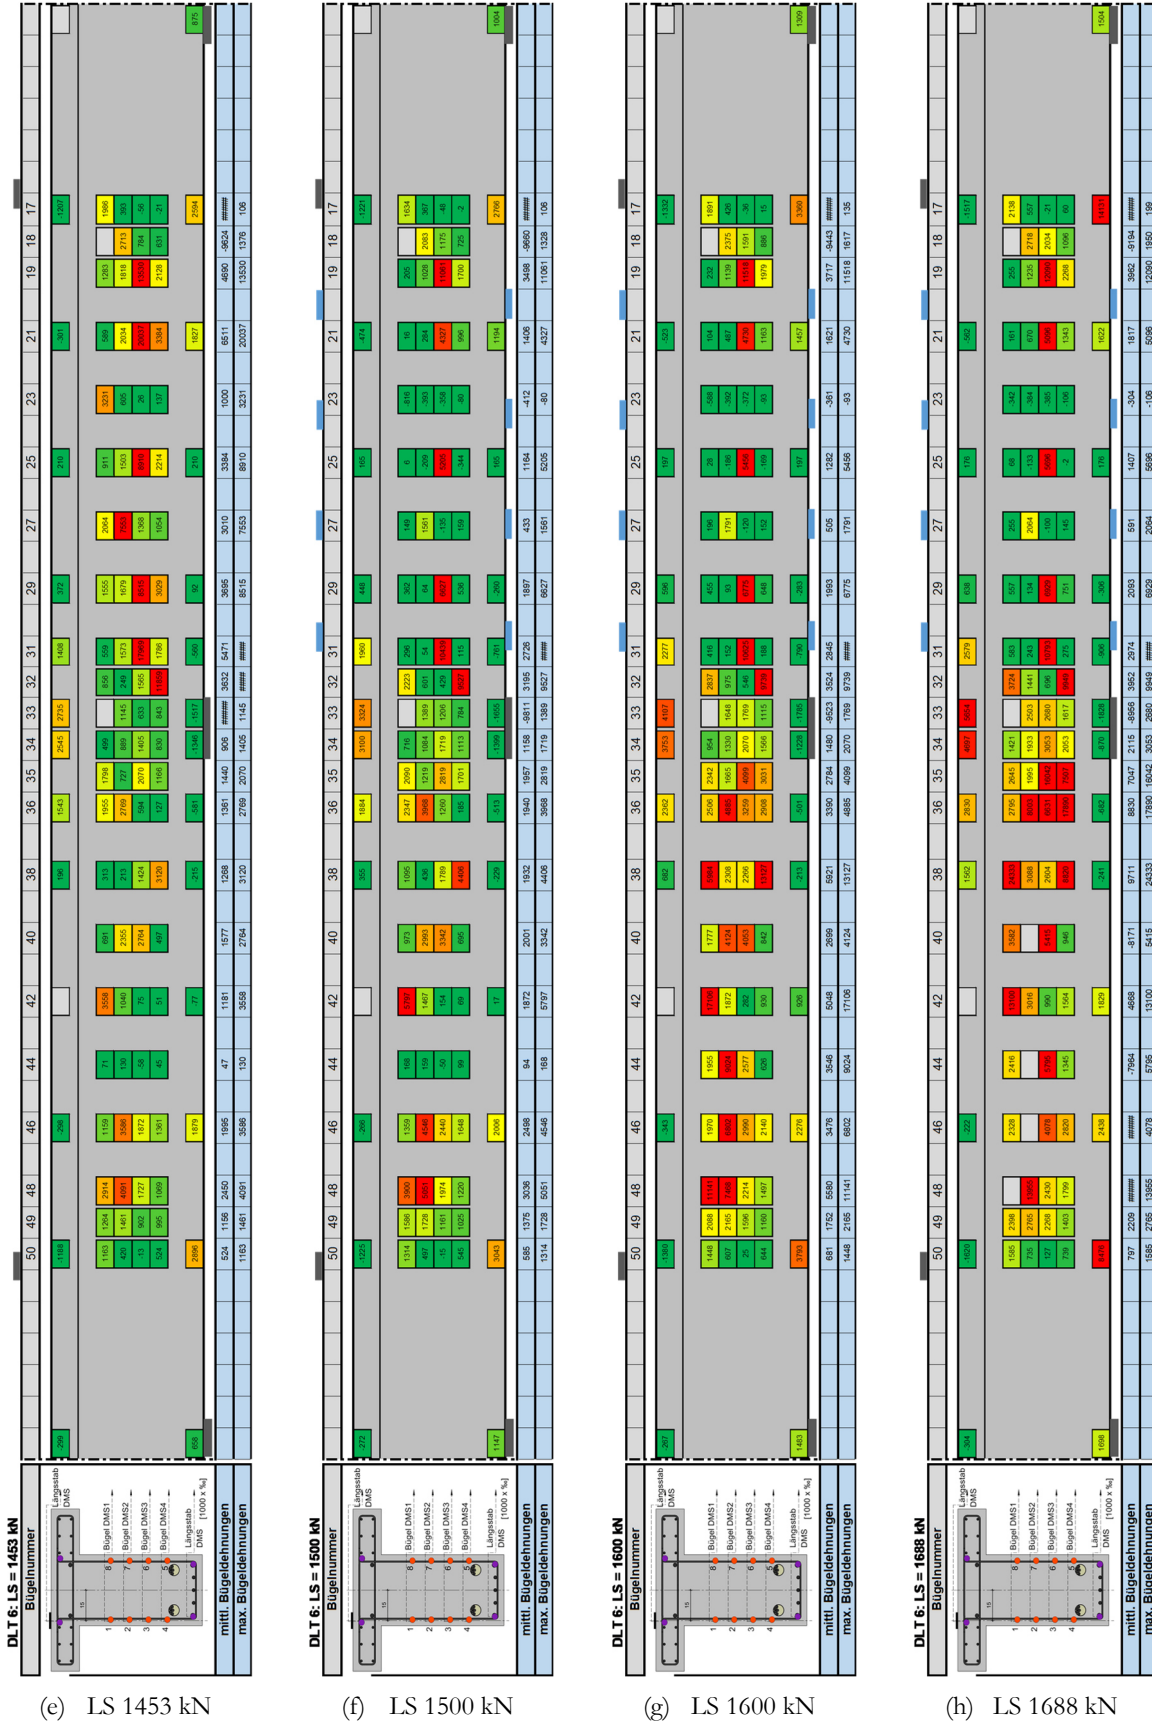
Betonstahldehnungen des Versuchsträgers DLT 6 für ausgewählte Laststufen – Vorderseite, Teil 2
